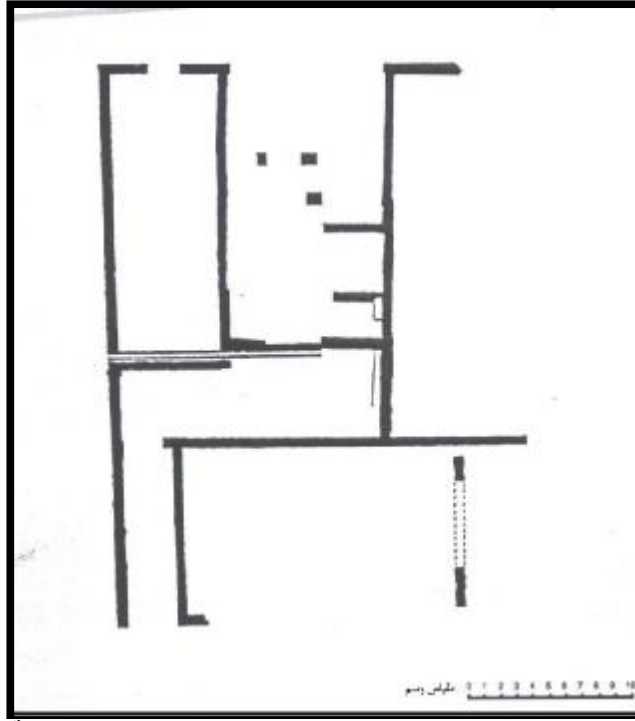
مسقط أفقي لمبنى الكنيسة المركزية
